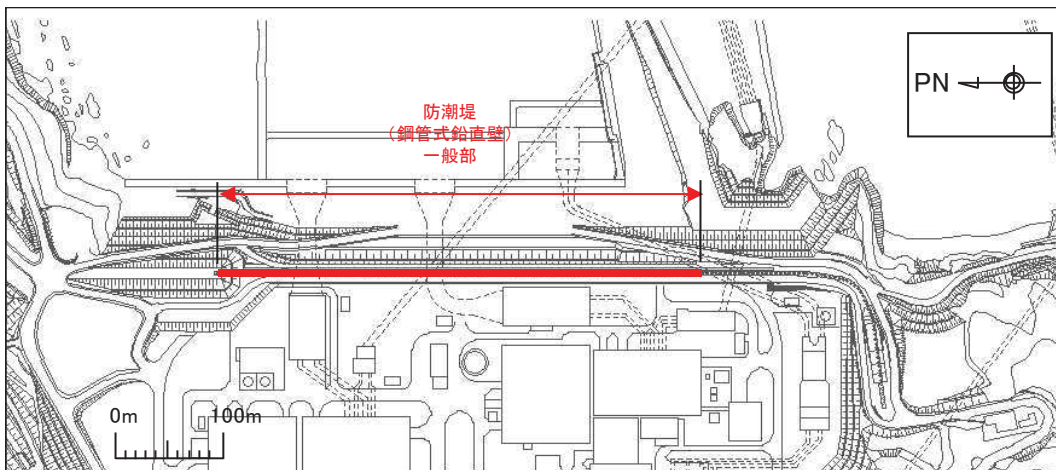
鋼管式鉛直壁（一般部）の平面配置図
